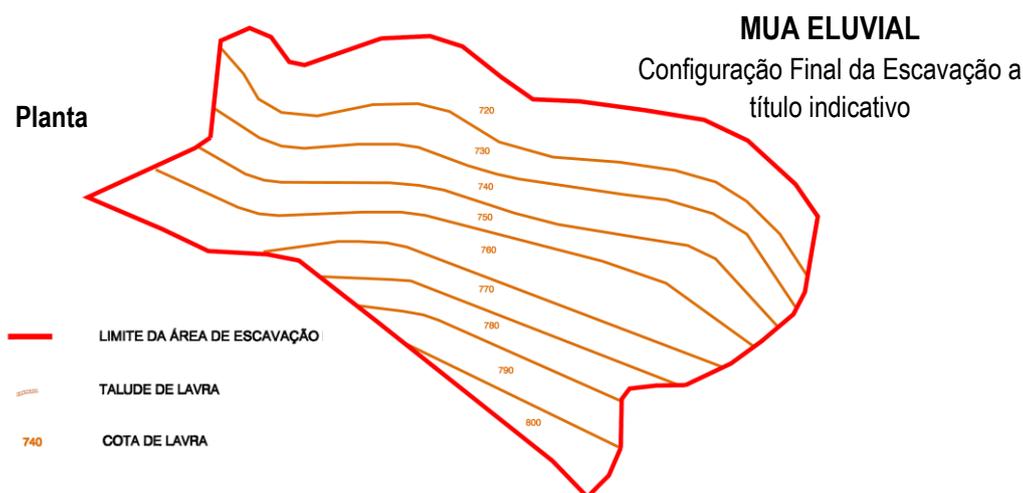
Configuração final de escavação no jazigo eluvial da Mua, em planta, a título indicativo.
